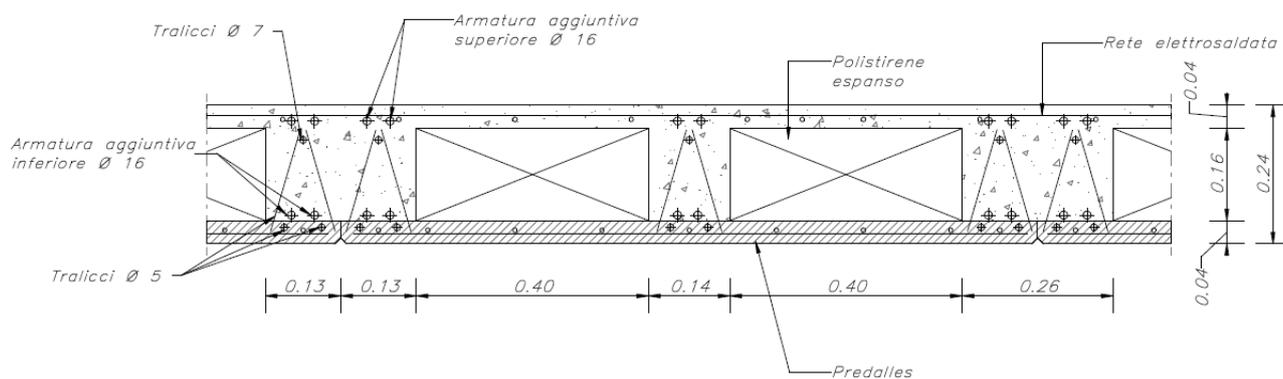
Dettaglio solaio predalles con indicazione armature
